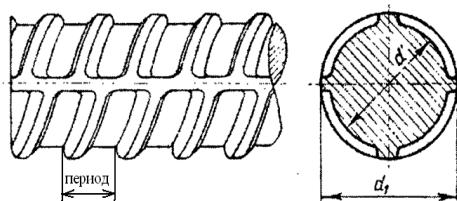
Профиль периодического сечения - арматурная сталь
